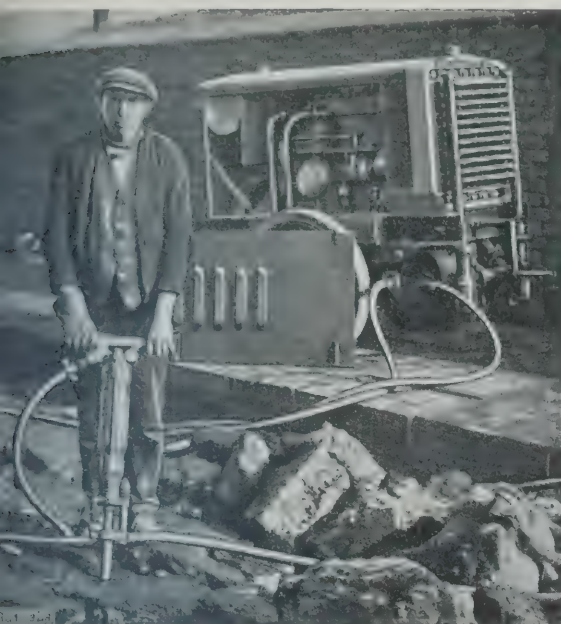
Betonaufbruchhammer der Firma Flottmann, A.-G., im Straßenbau.
